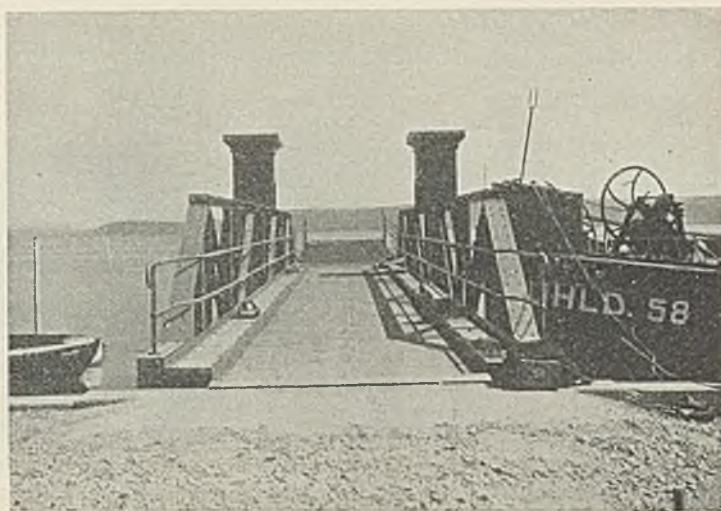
Landebrücke in Konstanz-Staad. Blick auf die Fahrbahn mit Brückenklappe.
